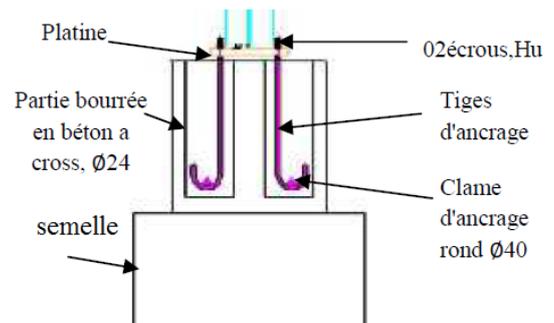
Articulation pied de poteau-fondation. Source :
